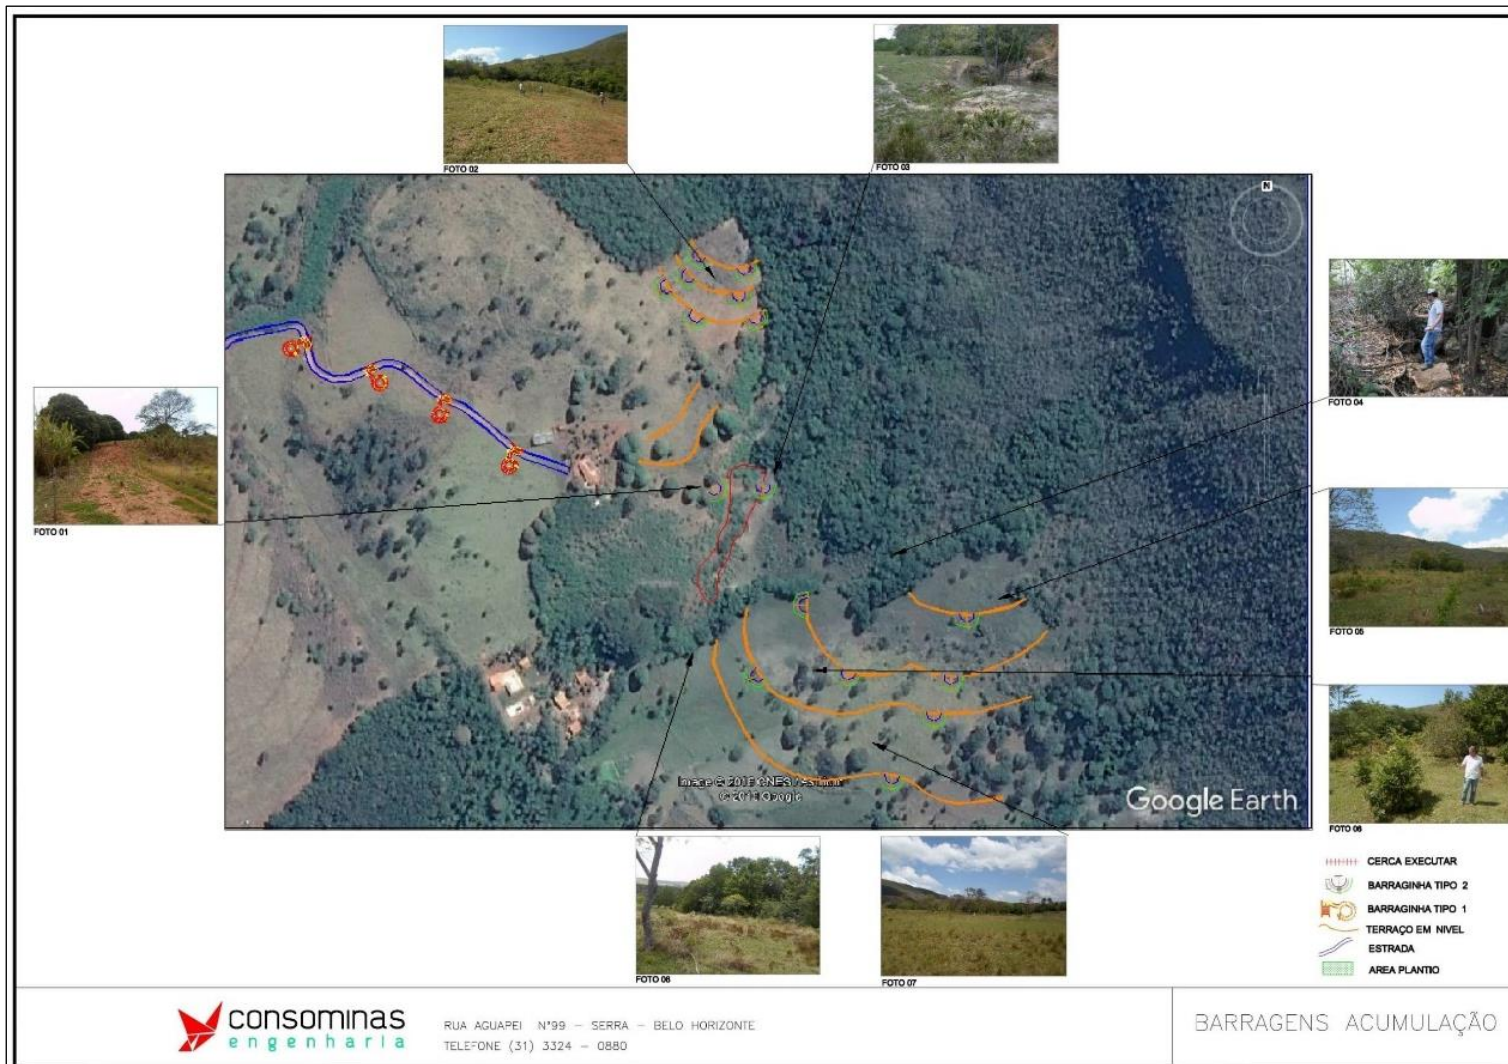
Croqui 05 – Complexo de ações – Área 4
